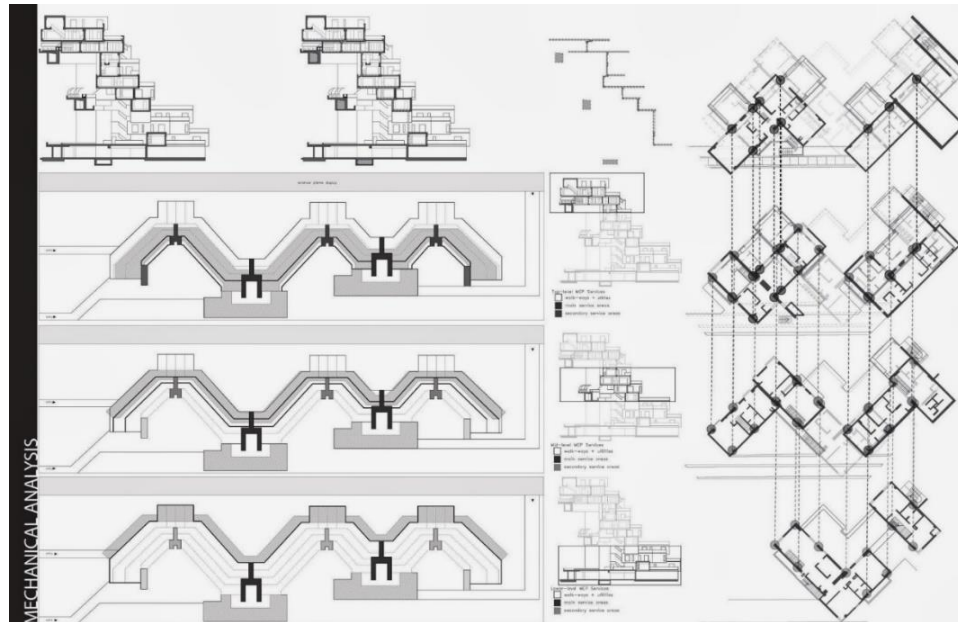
Схема генплану ділянки Хабітат 67. Розрізи. Планувальна структура житлових чарунок [12]
